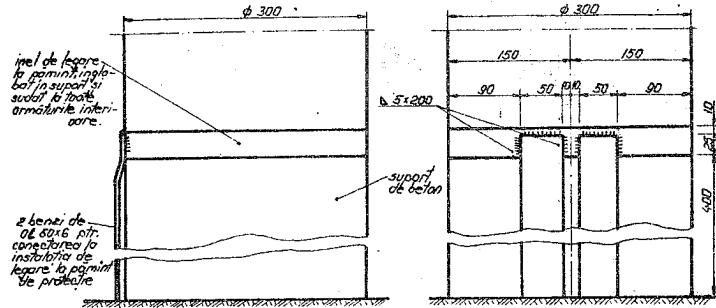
Detaliu de legare la pămînt a suportilor de beton pentru susținerea aparatelor.
